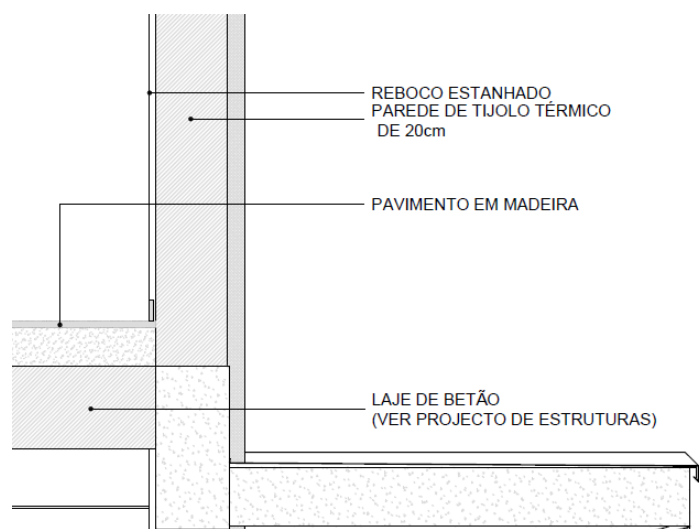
Pormenor construtivo do piso 1 (arquitetura)
